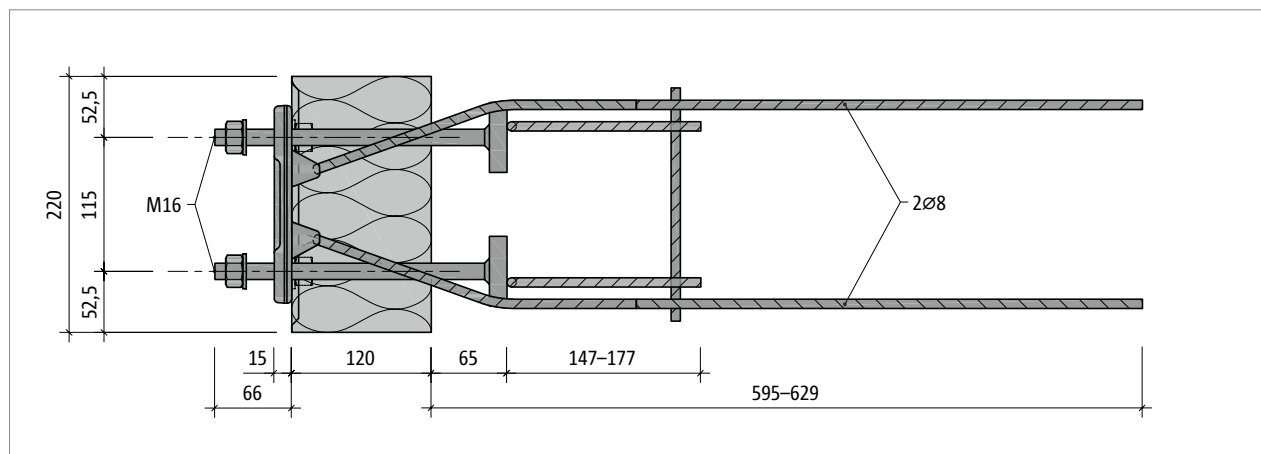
Schöck Isokorb® XT type SQ-V1 : vue en plan
